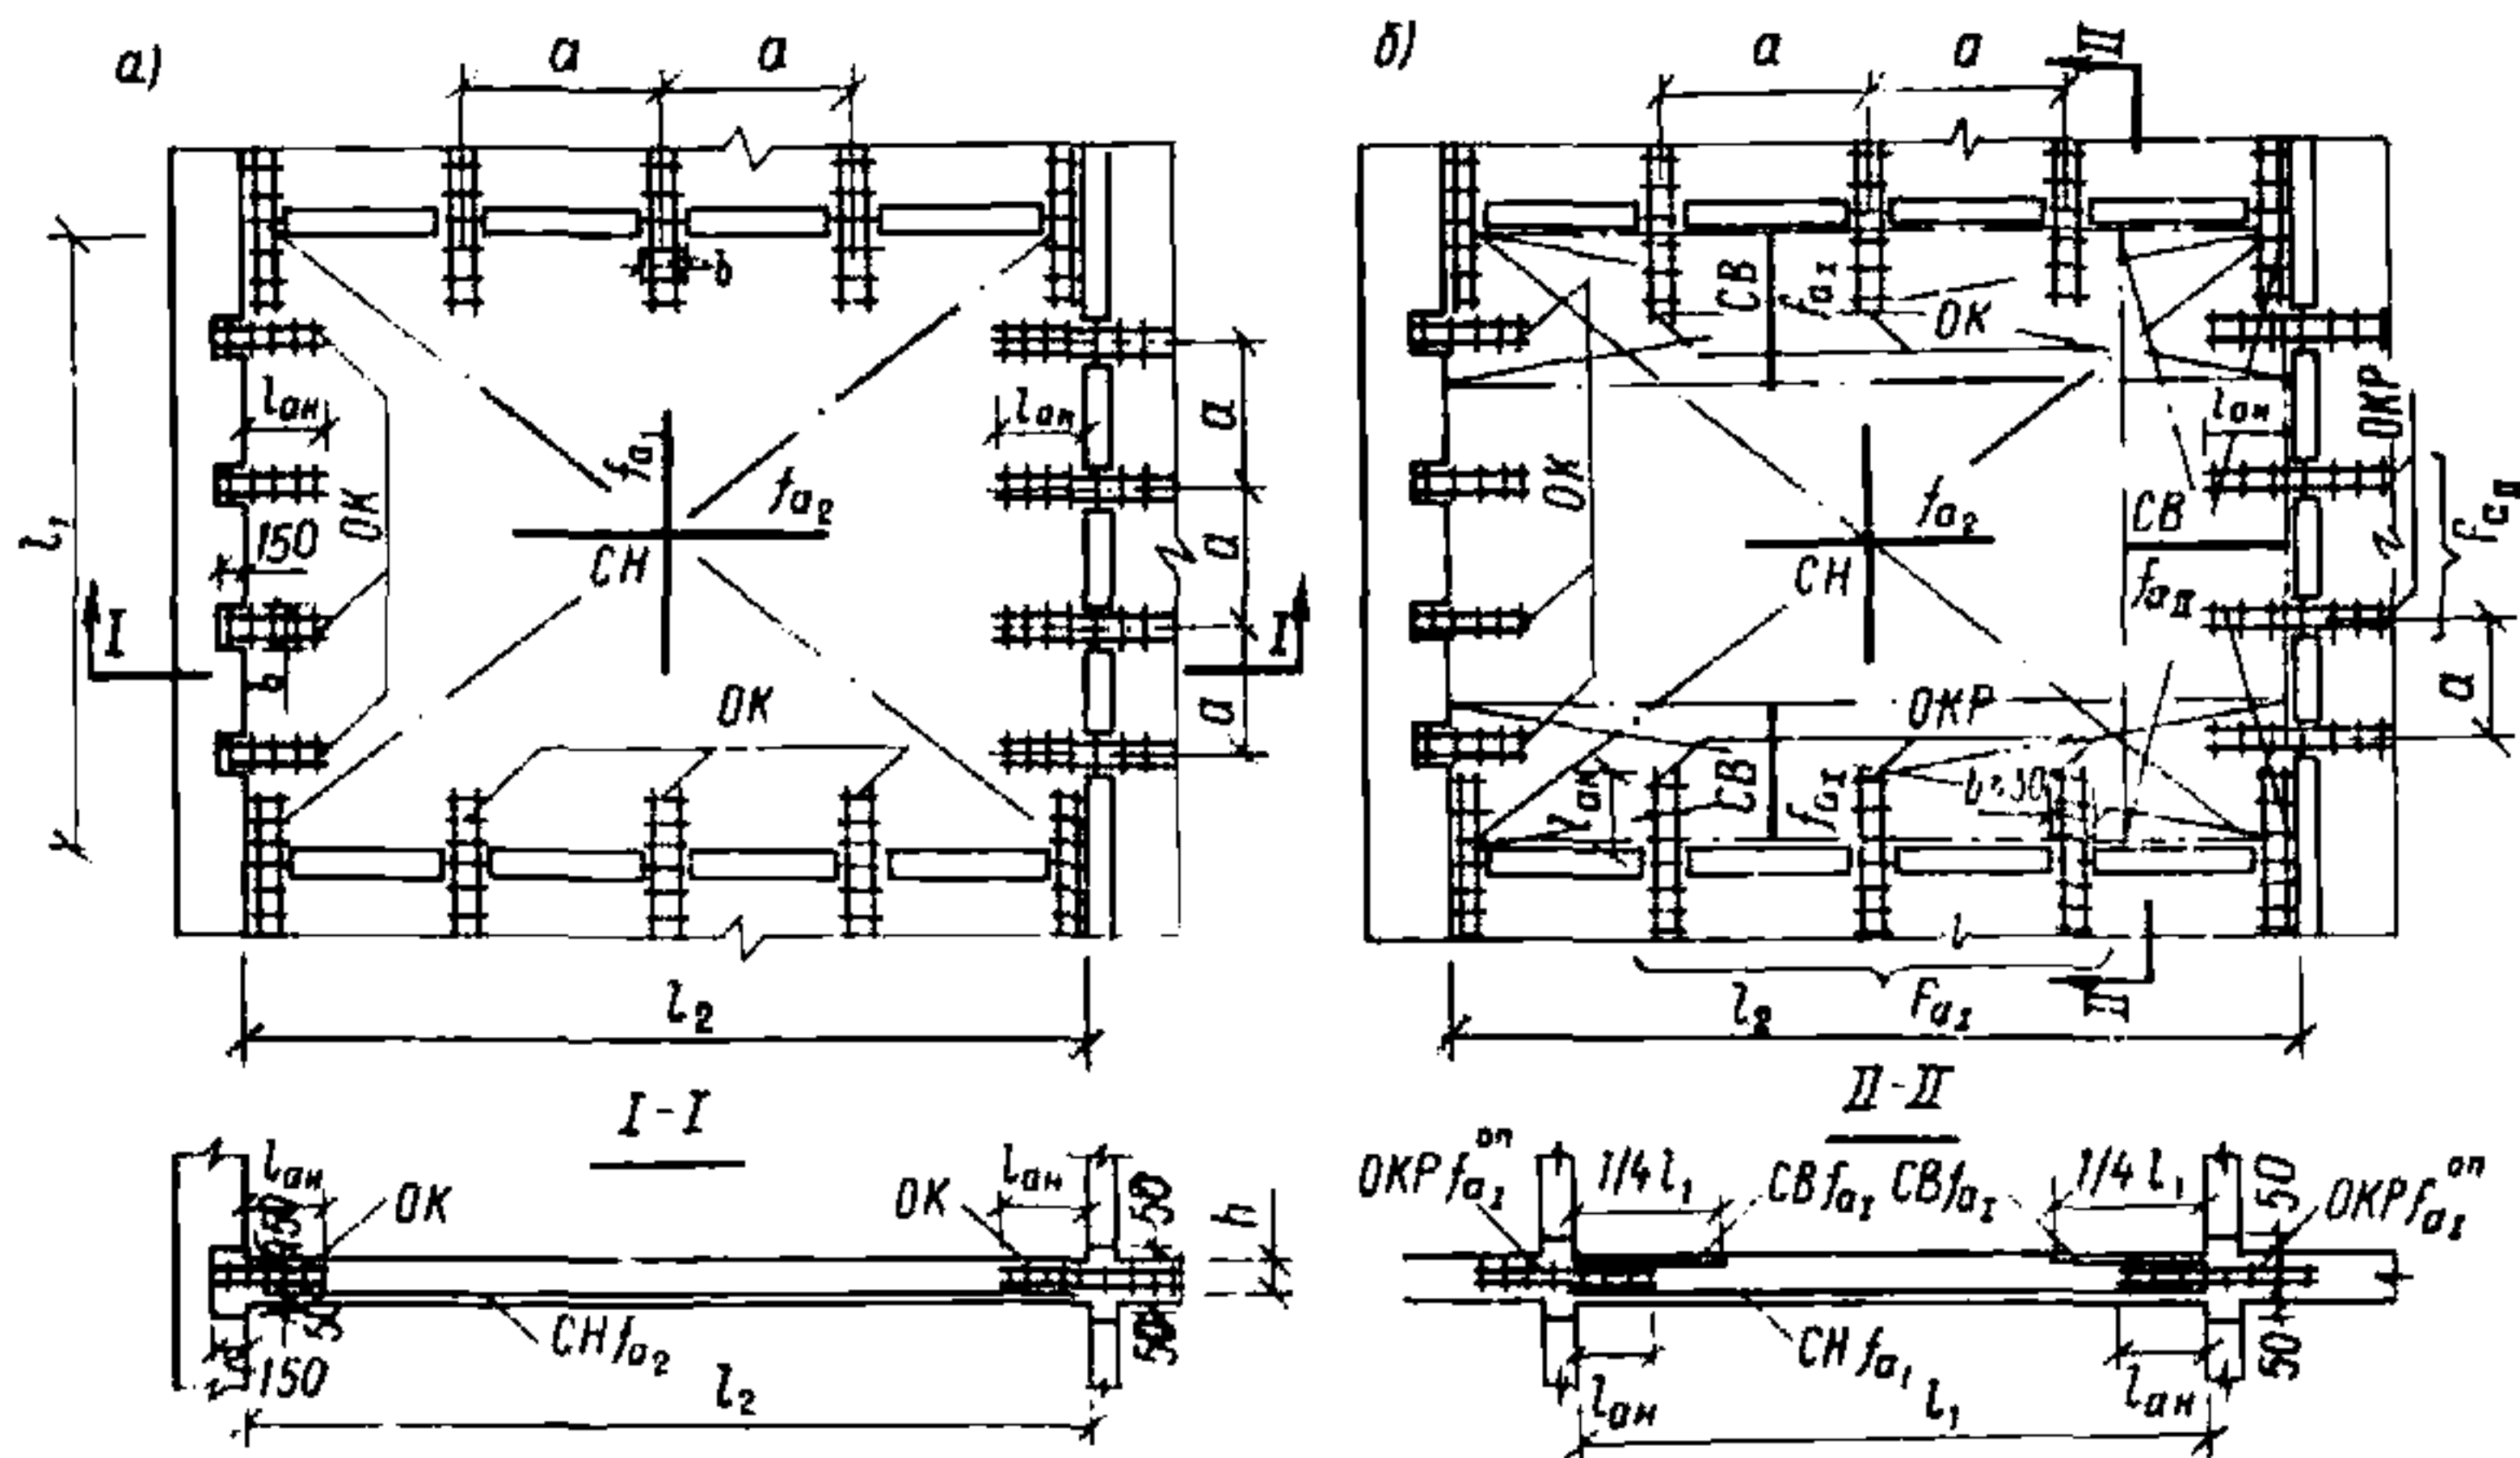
Схема армирования плиты с прерывистым опиранием
